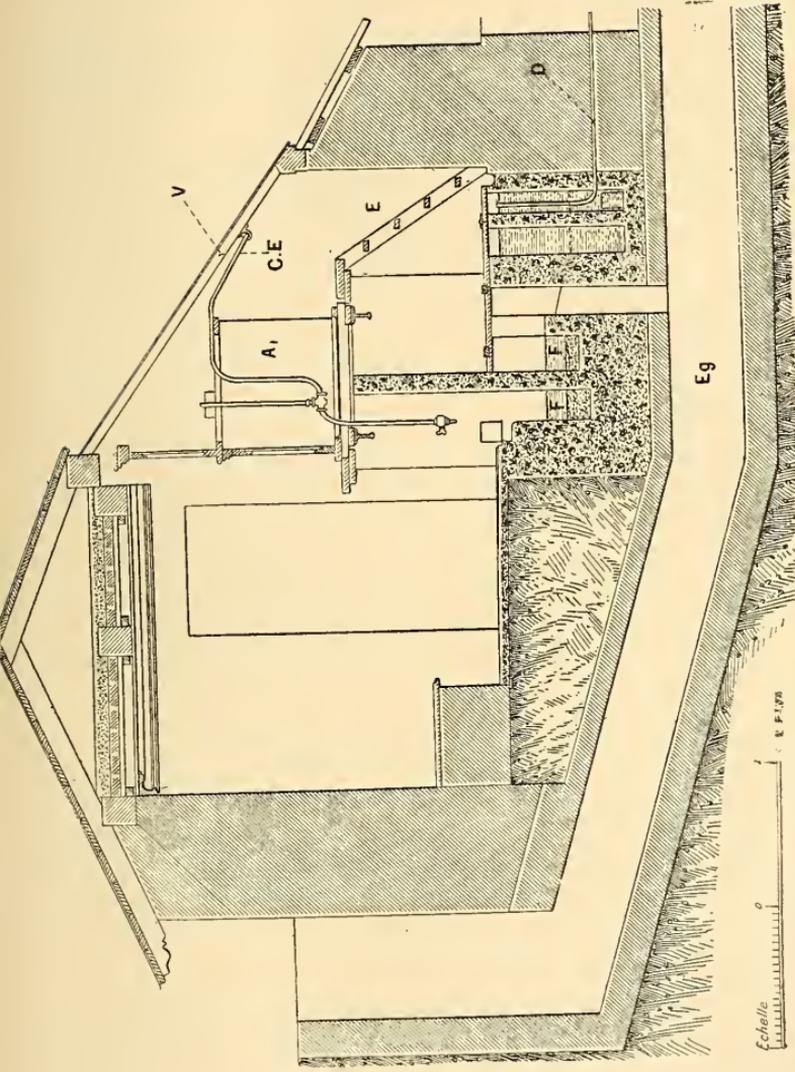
Coupe de la partie centrale de la serre, traversant l'égout (Eg) suivant une ligne passant par Eg et D de la figure 1. — L'échelle des proportions est indiquée en mètres.
